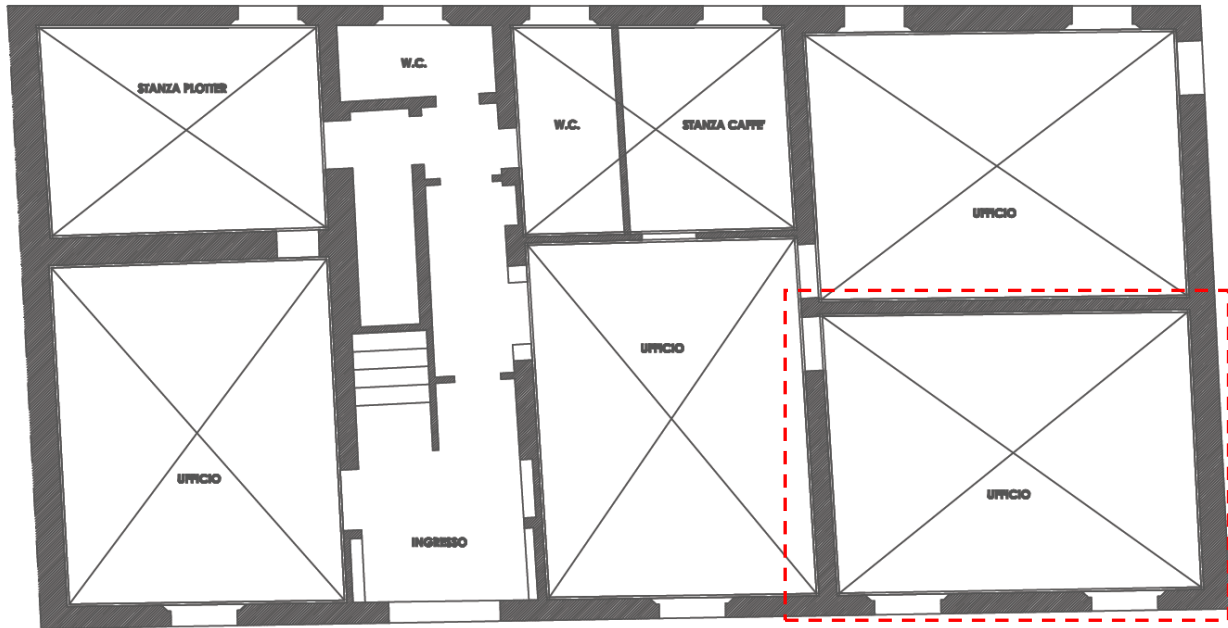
Pianta piano terra, con rappresentazione della reticolare di irrigidimento
